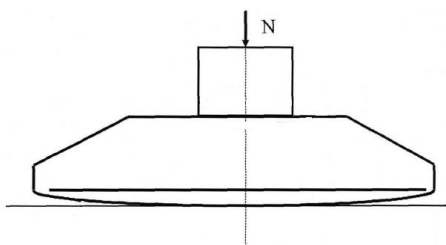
Конструкція стрічкового фундаменту з опуклою поверхнею опираючої
